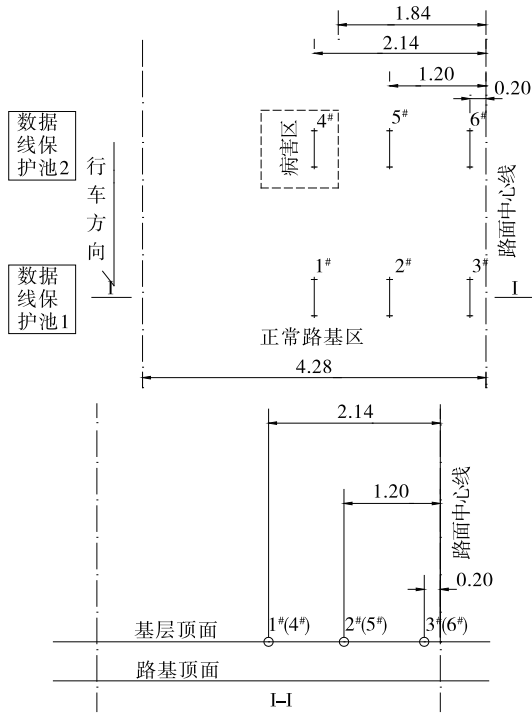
砼路面底面钢筋应变计布置示意图(单位:m)
